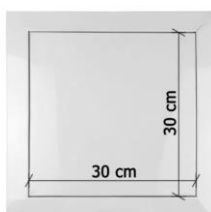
Detalhe Típico para forro em drywall estruturado
